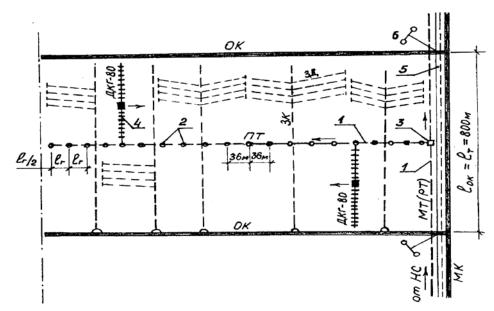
Фрагмент схемы орошения осущаемых земель дождеванием (на примере дождевальной машины ДКГ-80)
